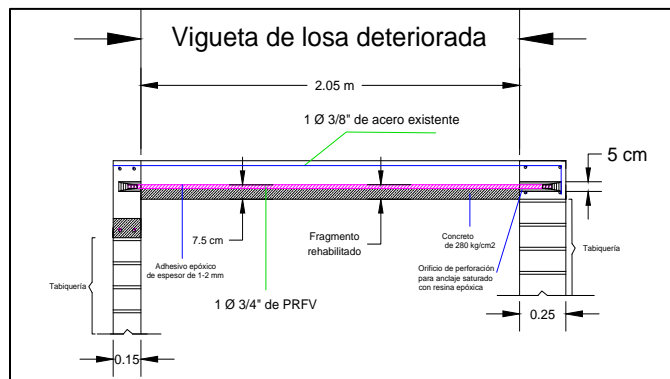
Esquema de rehabilitación de viguetas de losa de concreto con refuerzo de PRFV, según análisis.
